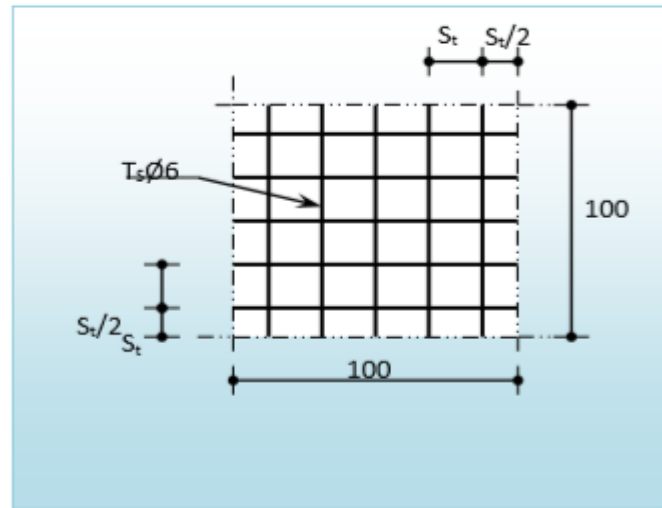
ferrailage en treillis soudé de la dalle de compression
